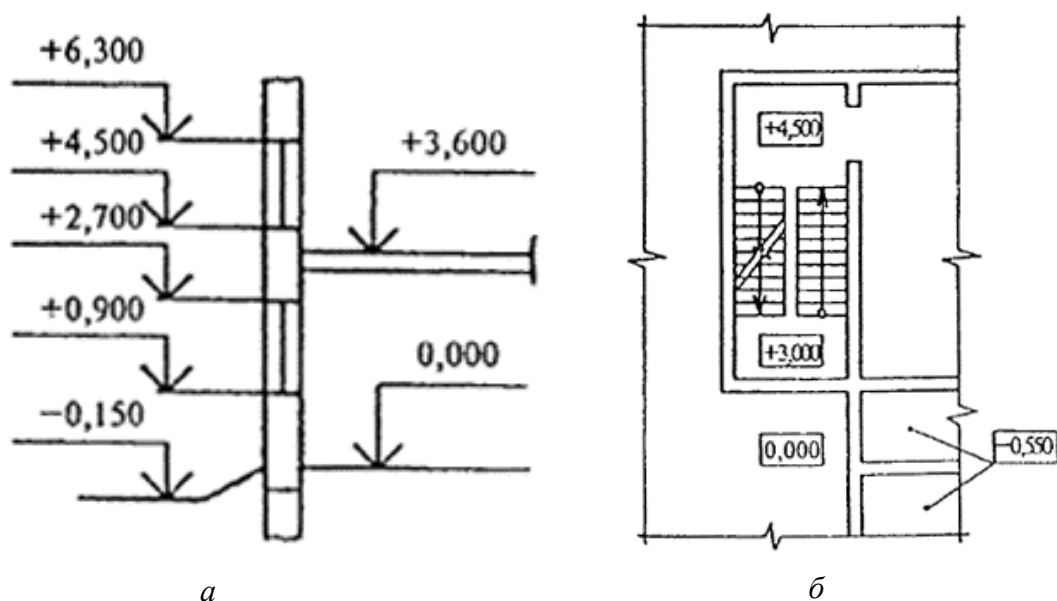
Нанесение отметок на фасадах и сечениях (а) и планах зданий (б)
